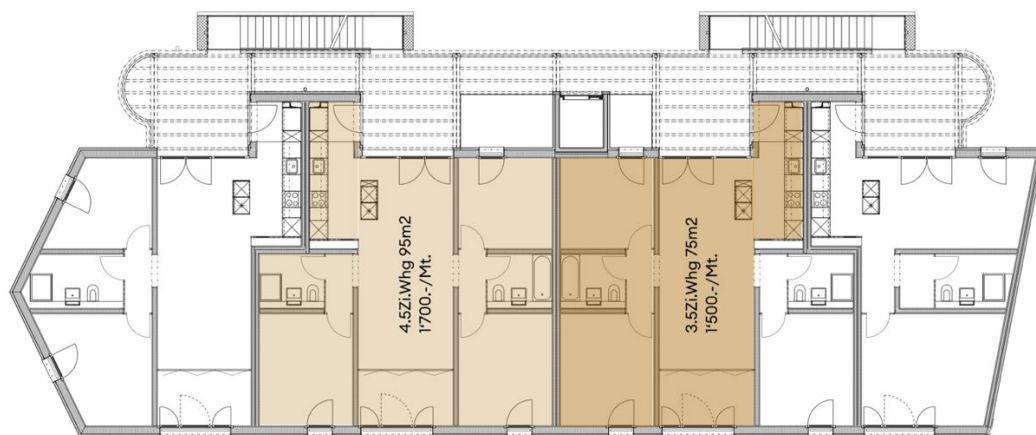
kompakte Grundrisse führen zu erschwinglichen Wohnungen
